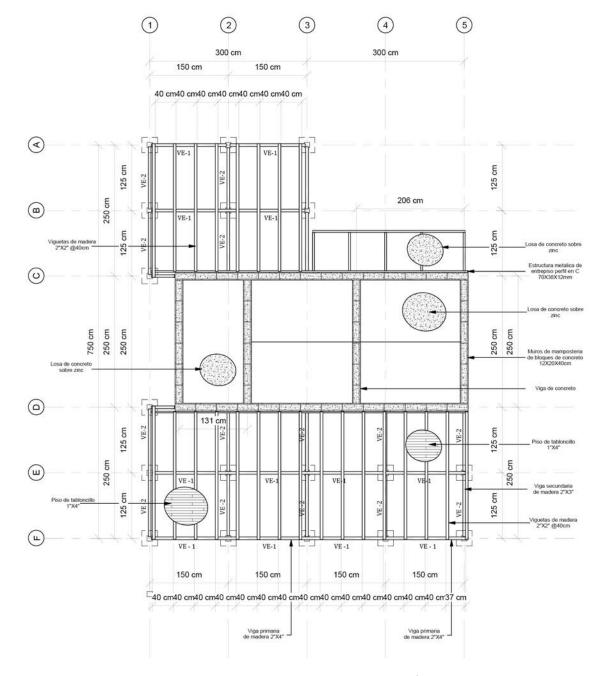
Planta Estructural de Entrepiso Vivienda Gran Área Metropolitana Fuente: Elaborado por autor
